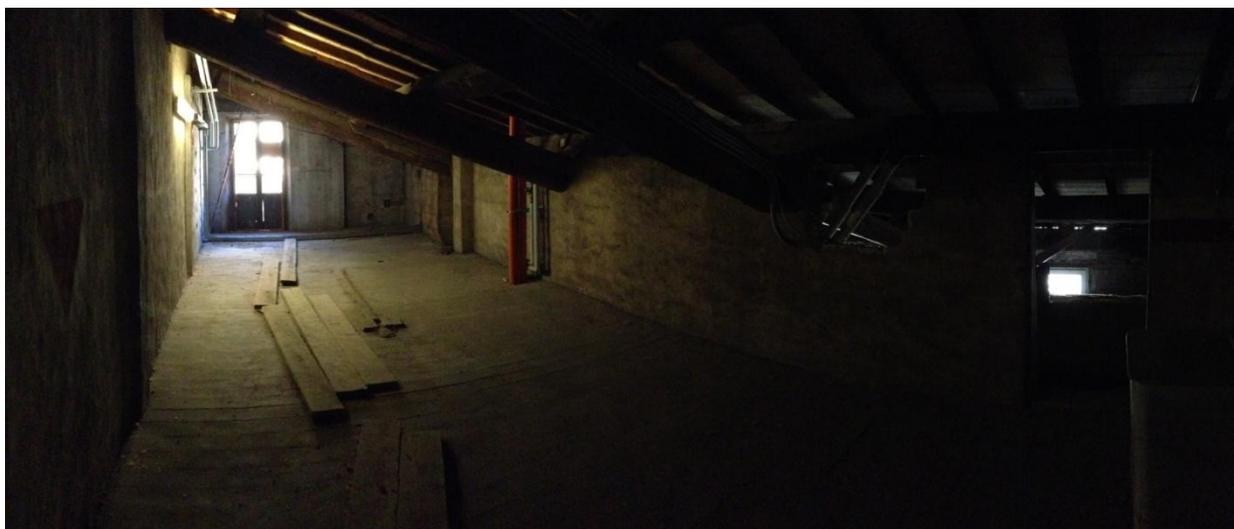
Abbassamento del pavimento in piannelle al piano sottotetto – solaio oggetto di consolidamento.
